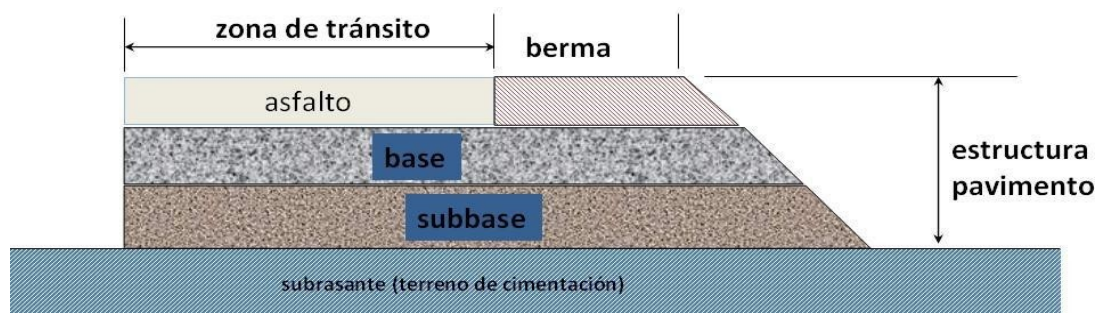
Estructura del pavimento flexible. Fuente: Becerra, M. (2012)
